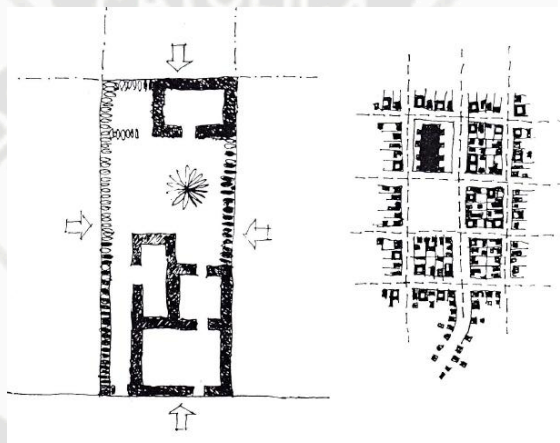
lado derecho vista general del pueblo, lado izquierdo vista de detalle de un grupo de asentamiento de vivienda - fuente: Jorge Burga, vivienda popular en Cajamarca
